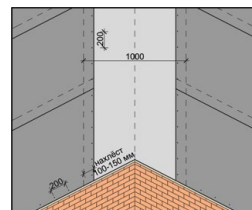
Схема монтажа подкладочного ковра Döcke PIE Standard PLUS в ендове и на смежных скатах
